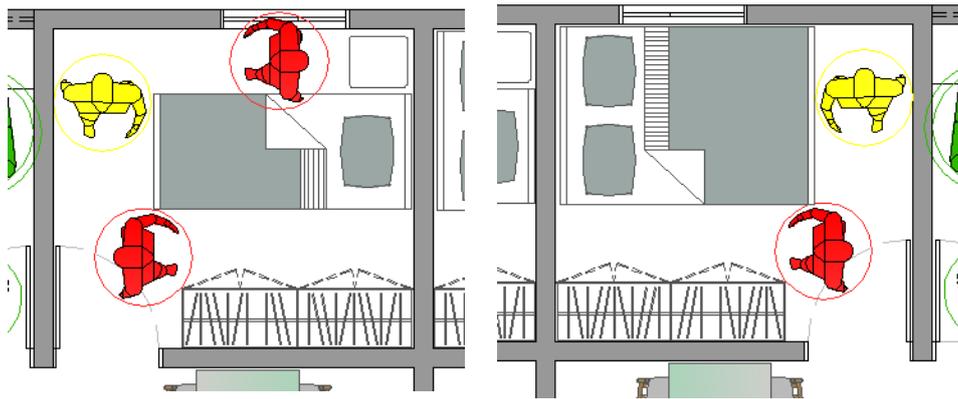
Unidade habitacional – Planta Baixa e *Layout*.
